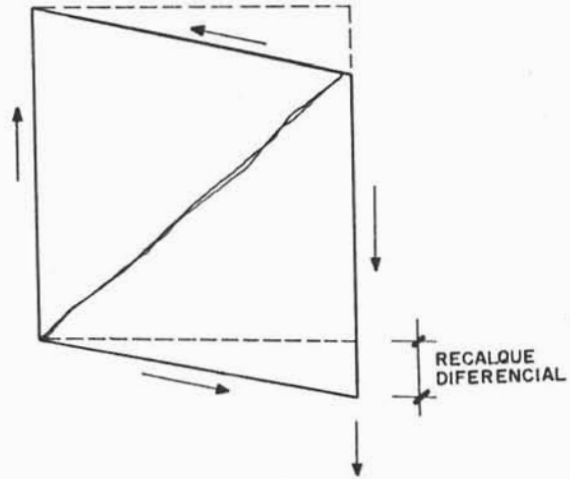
Fissura em parede de concreto por recalque diferencial (URIEL ORTIZ<sup>94</sup>).
